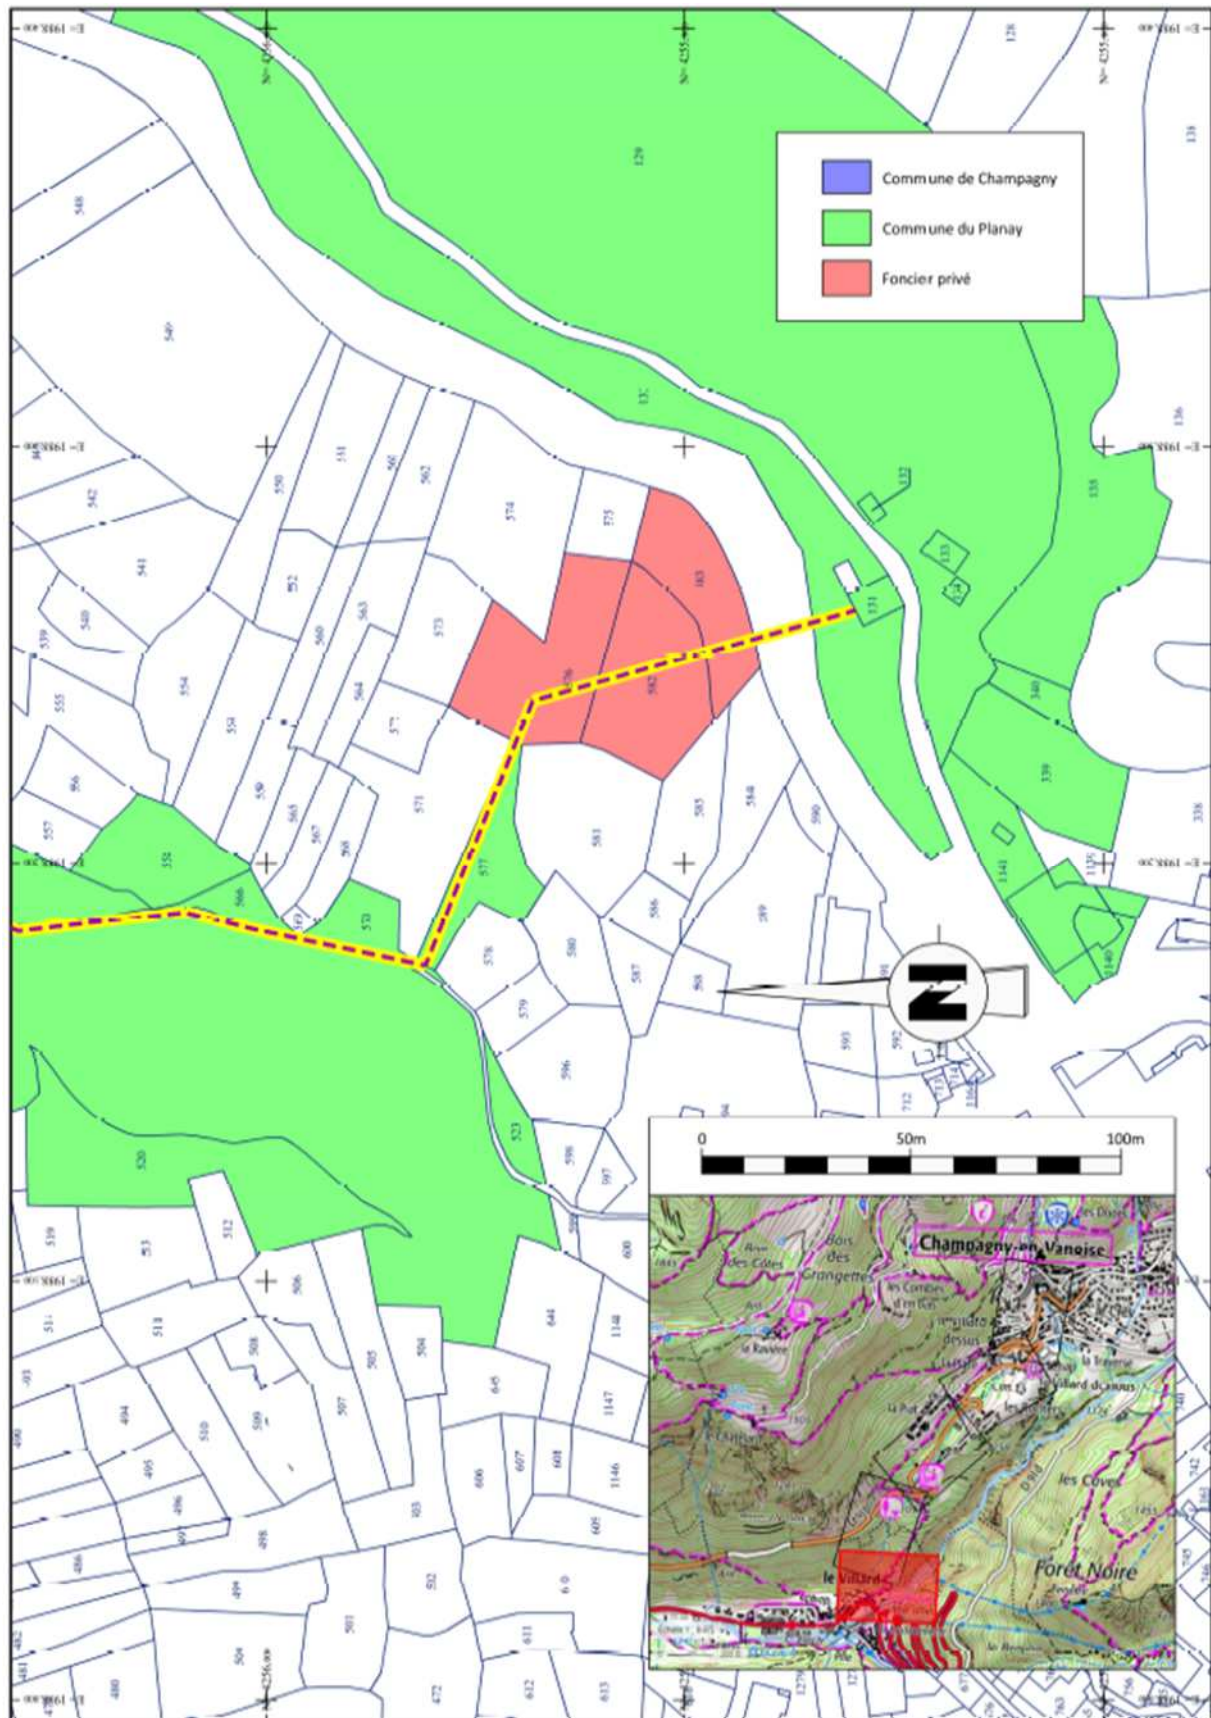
Implantation des ouvrages sur fond de plan cadastral - planche 5/5
